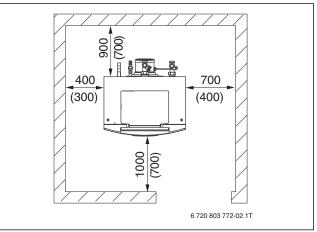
Wandabstände im Aufstellraum: Empfohlene und minimale Wandabstände (in Klammern, alle Maße in mm)
